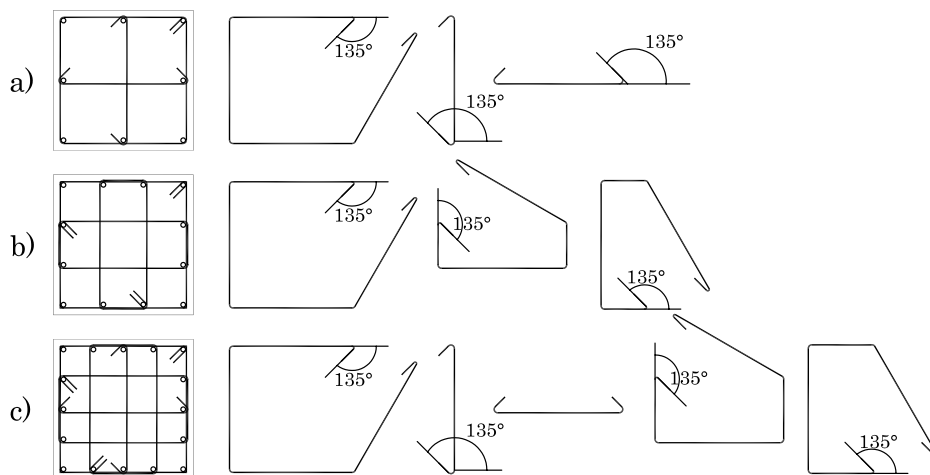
Detalle de armado transversal de columnas, con el doblés de los ganchos a 135°
